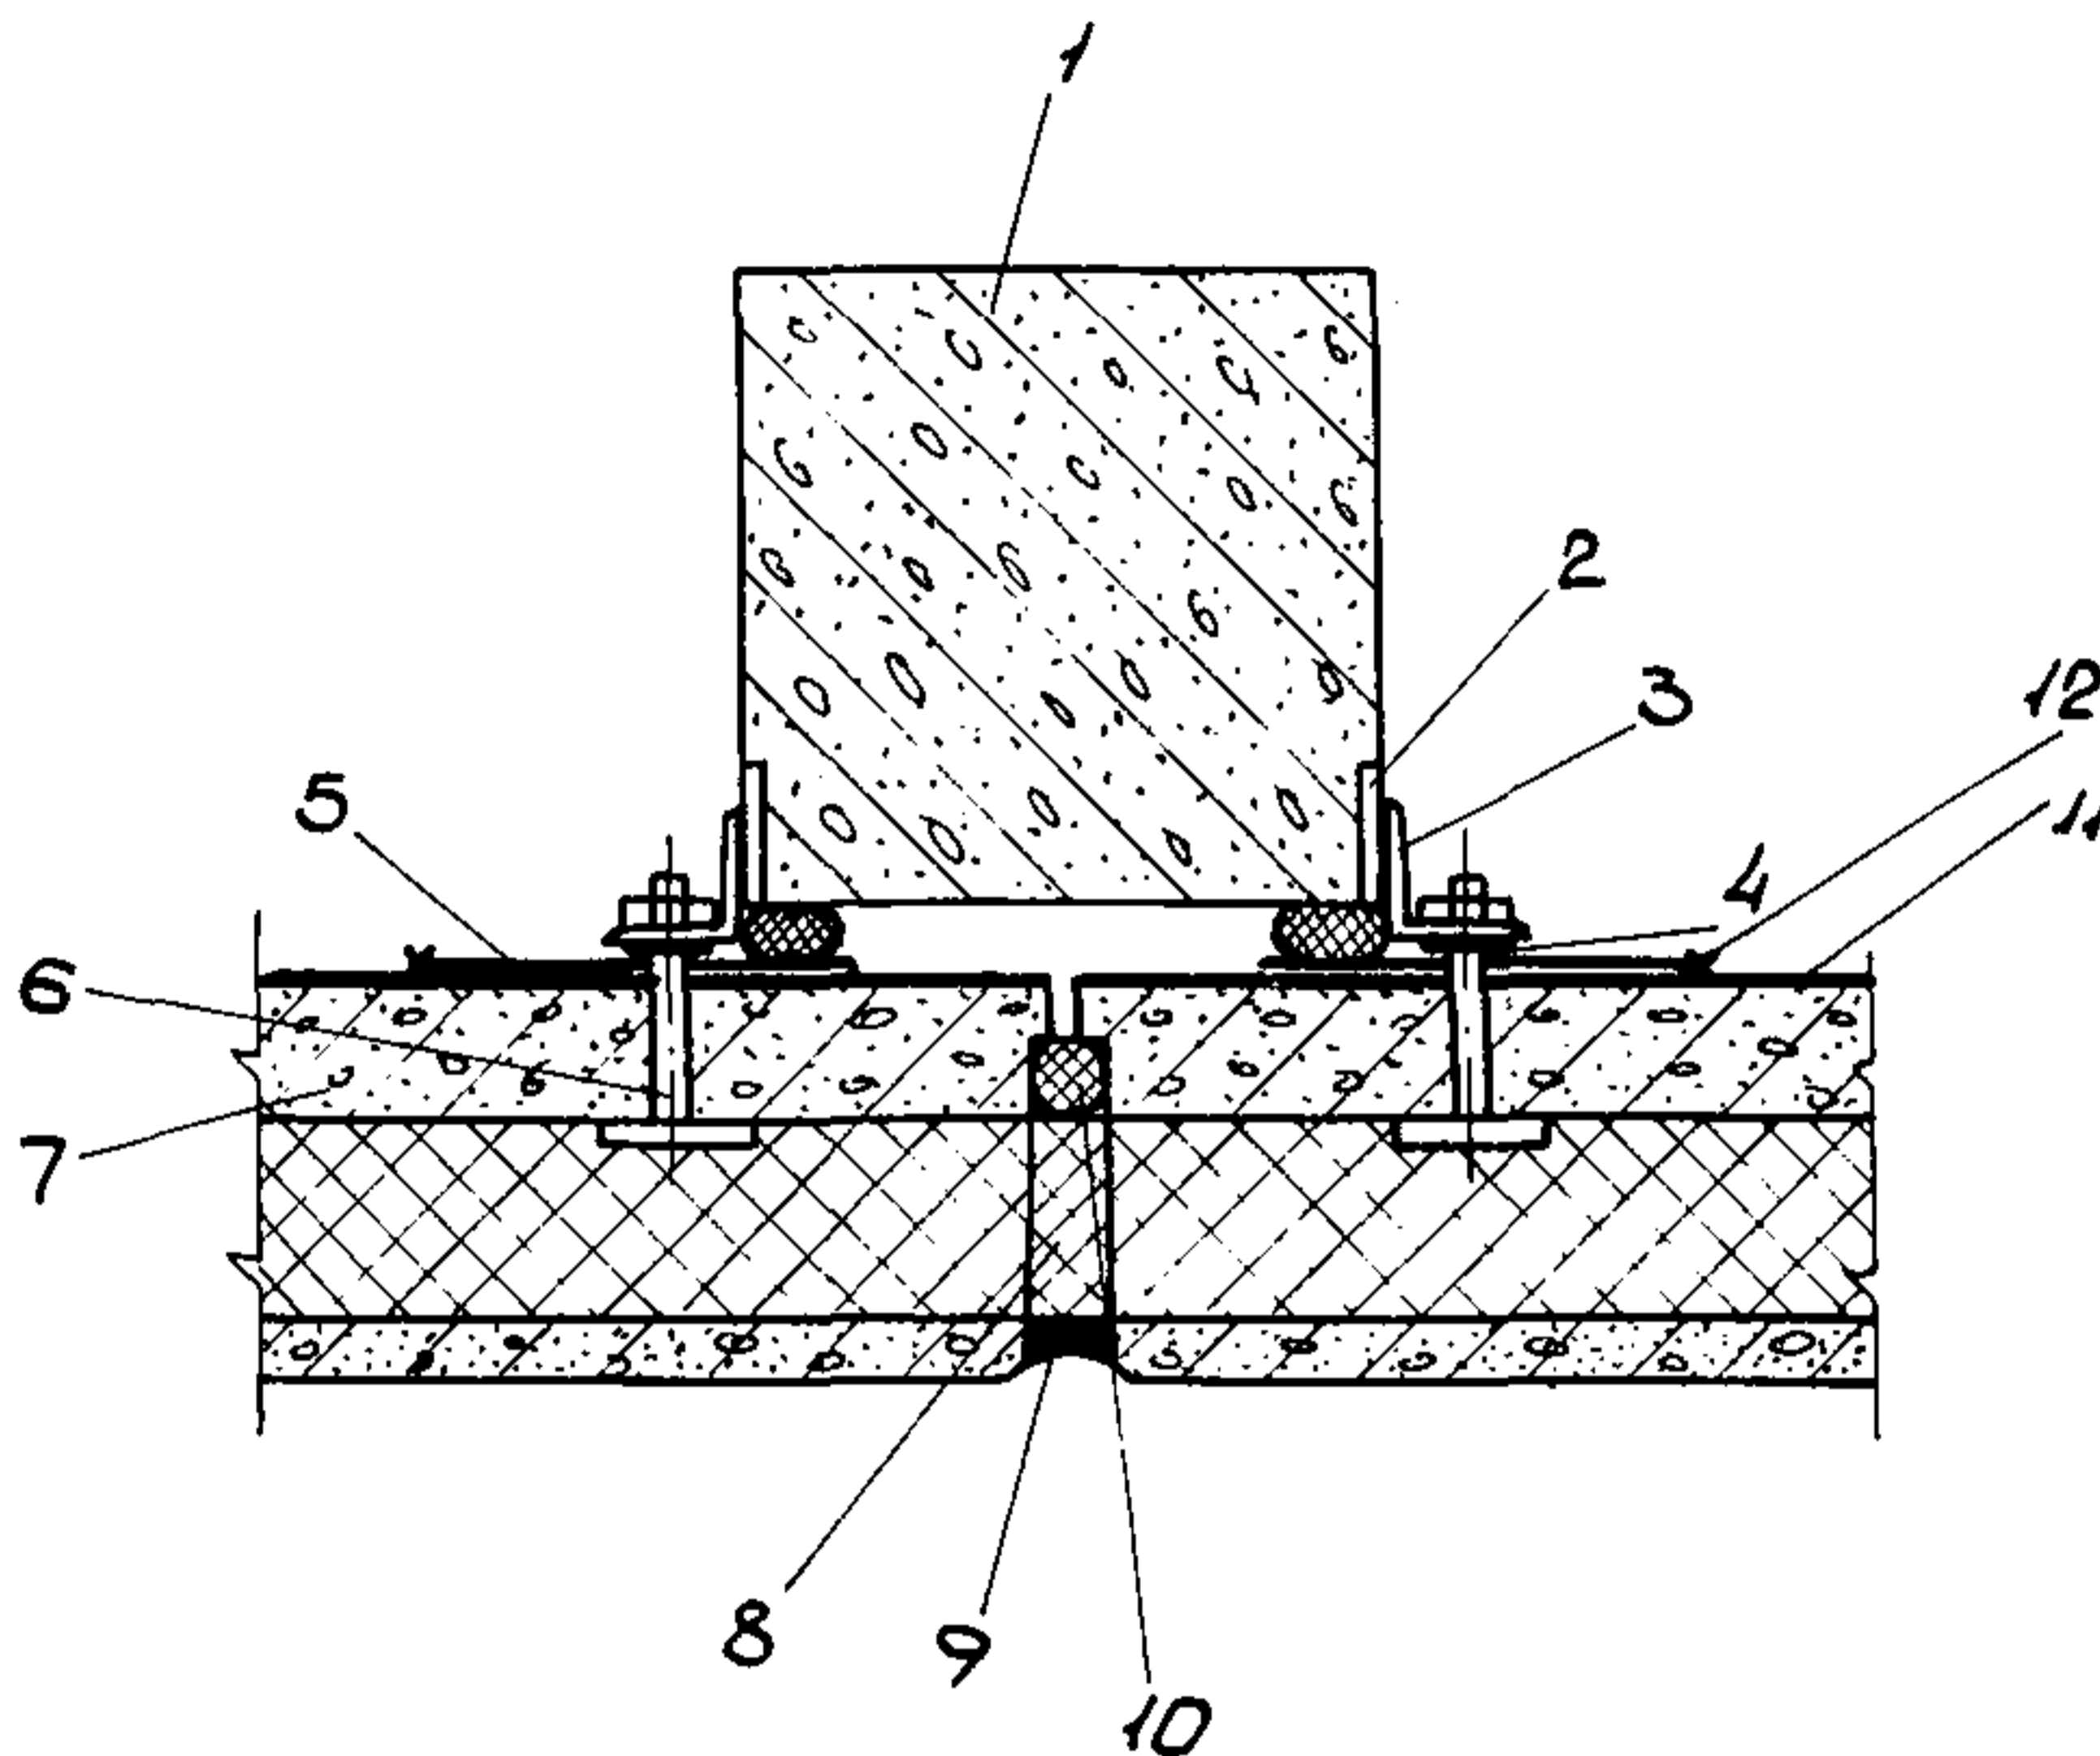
Вертикальный стык трехслойных железобетонных панелей на гибких связях с полиэтиленовым покрытием
